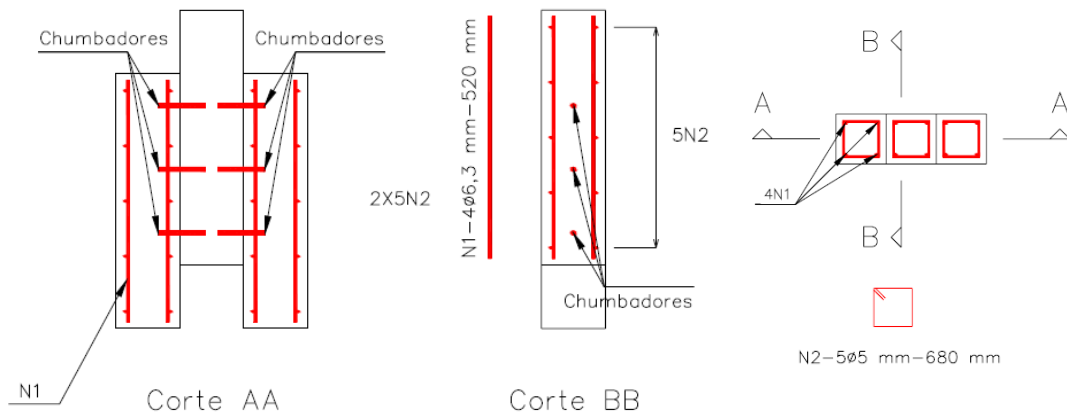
28 - Armadura e dimensões dos espécimes ensaiados por Risso (2008)
